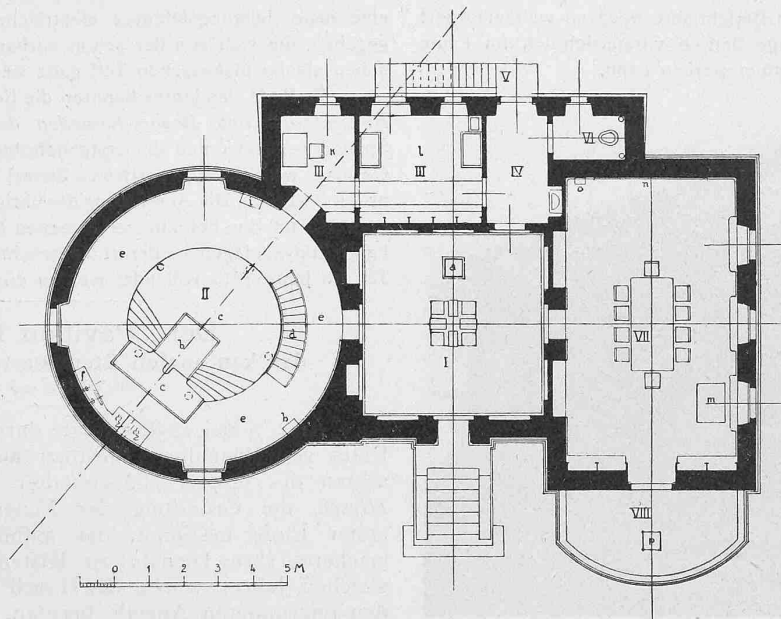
Grundriss vom Erdgeschoss. — Masstab 1 : 200.
